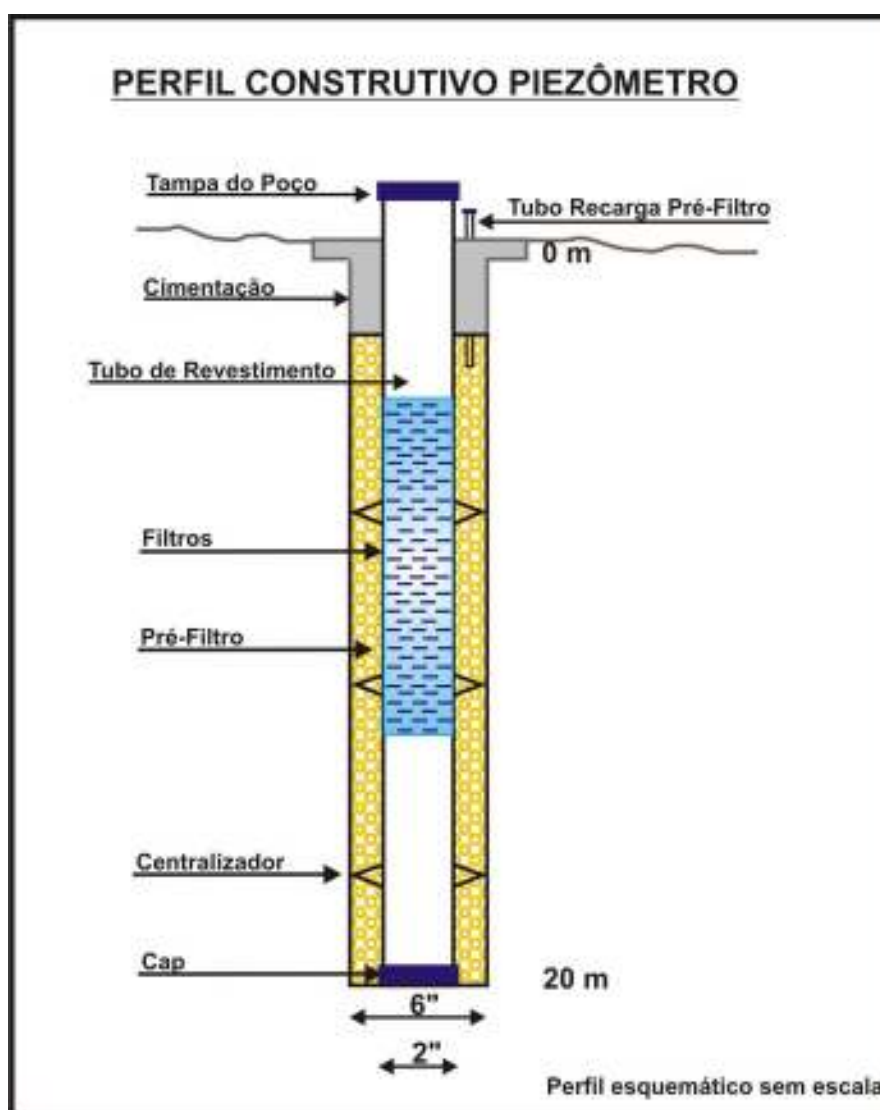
Perfil construtivo do piezômetro a ser instalado na área da ETE.
